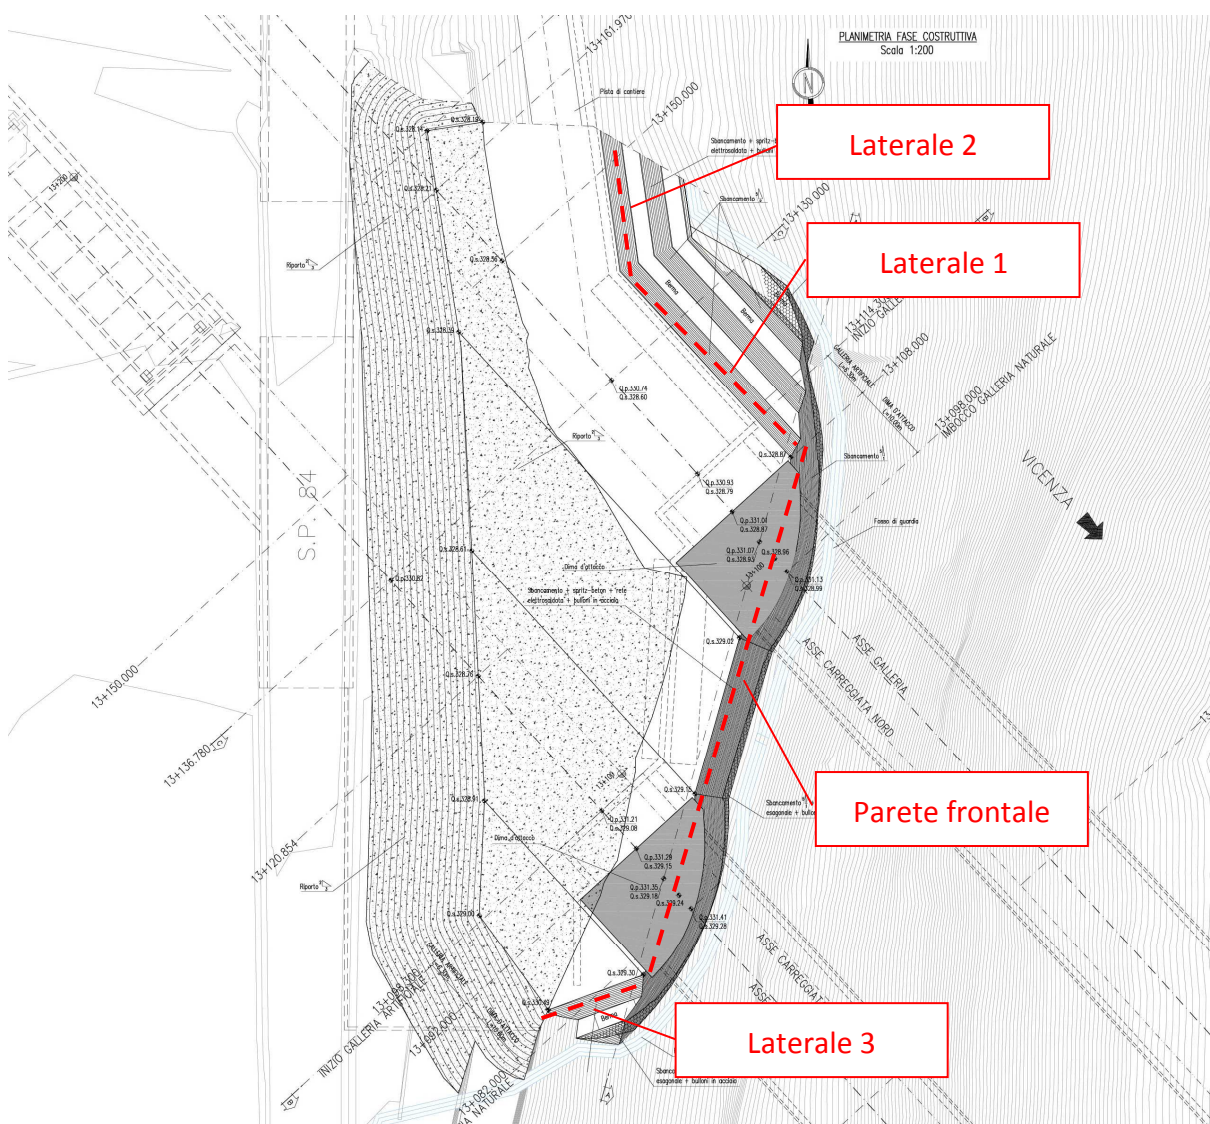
Stralcio planimetrico Imbocco Nord Galleria Pedescala
